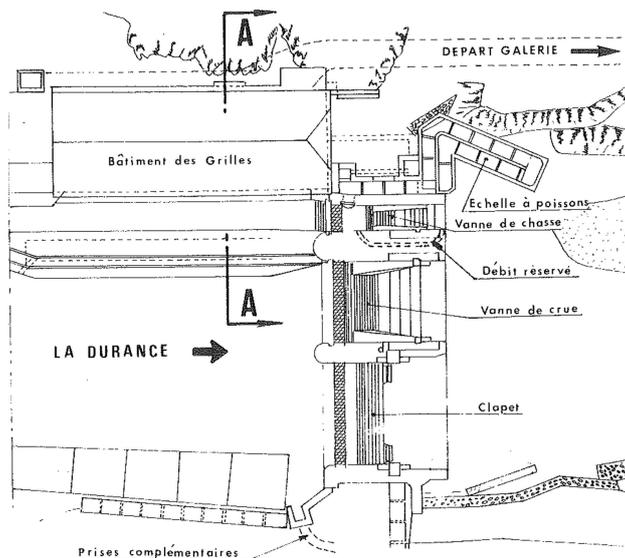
Plan de la prise d'eau EDF de Prelles sur la Durance
